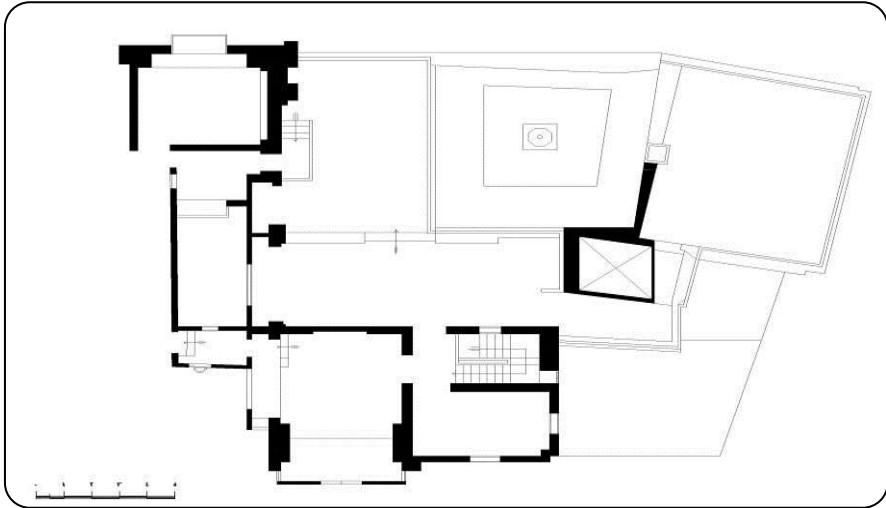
المسقط الأفقي للدور الثاني للبيت العثماني موضع الدراسة
